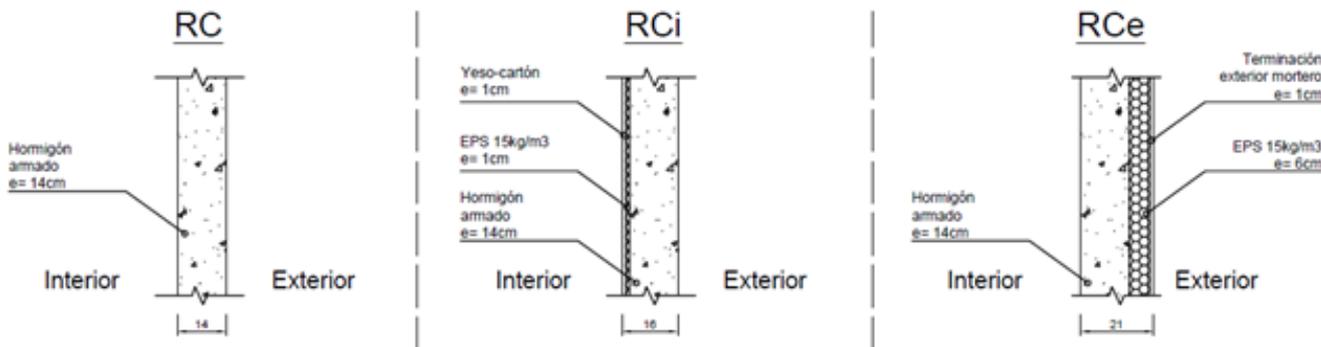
Escantillones de soluciones constructivas para hormigón armado. Fuente: CIM UC, 2019.
